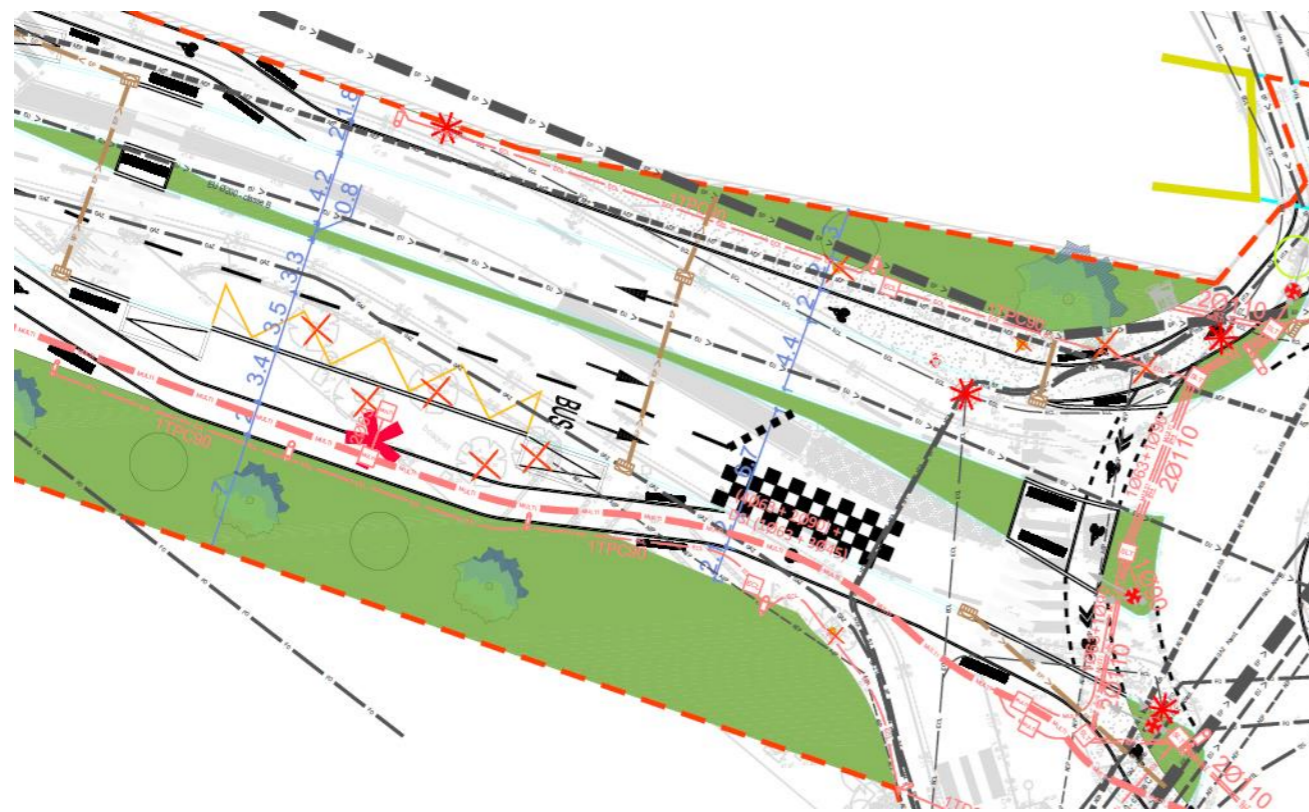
Plan des réseaux sur le Giratoire Sanitas (avenue Charles de Gaulle)
